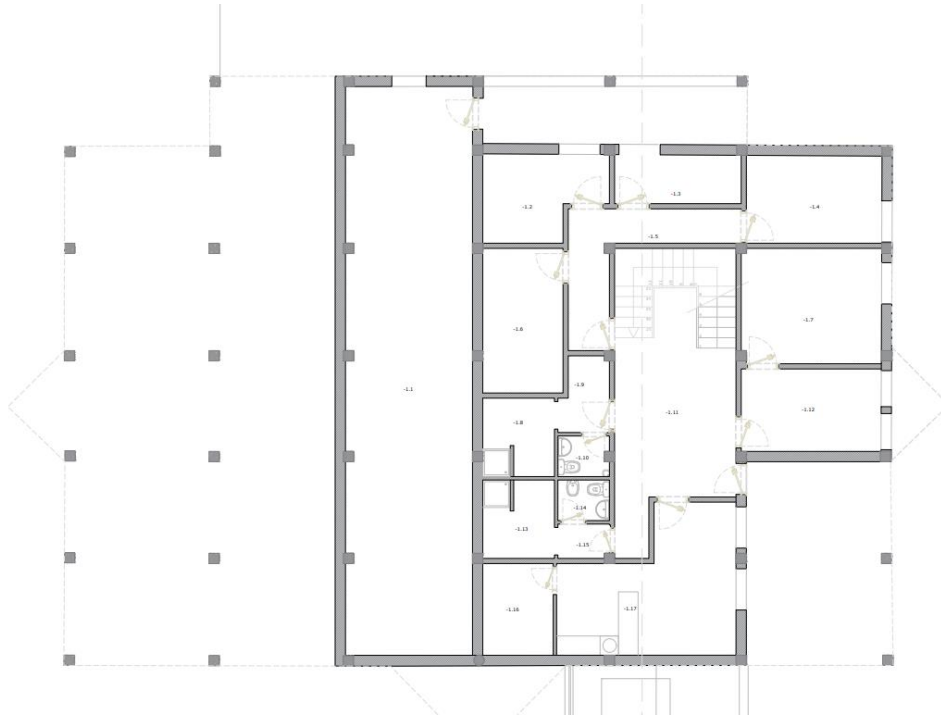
59 - Planta do Centro de Saúde do Tortosendo - Piso -1
